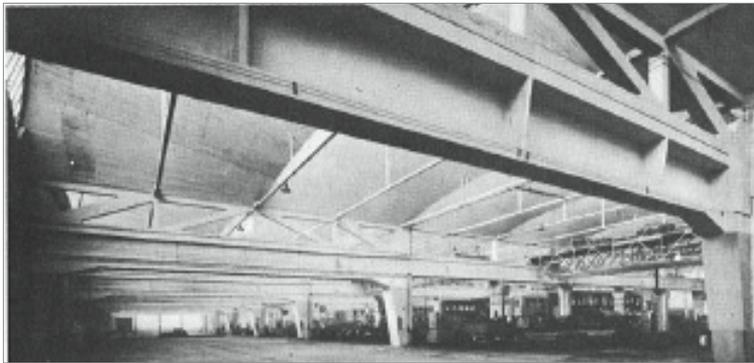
Vista de una viga recta de hormigón armado construida por Freyssinet en la fábrica nacional de radiadores en París.
